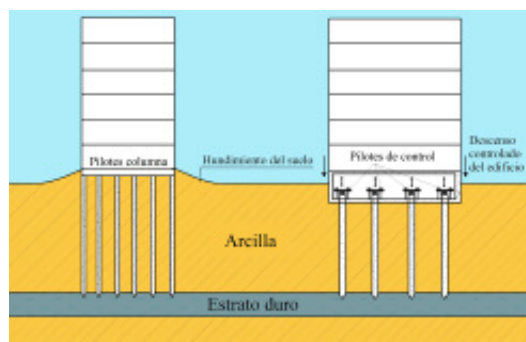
Ejemplo de cimentaciones realizadas con pilotes columna y pilotes de control.
